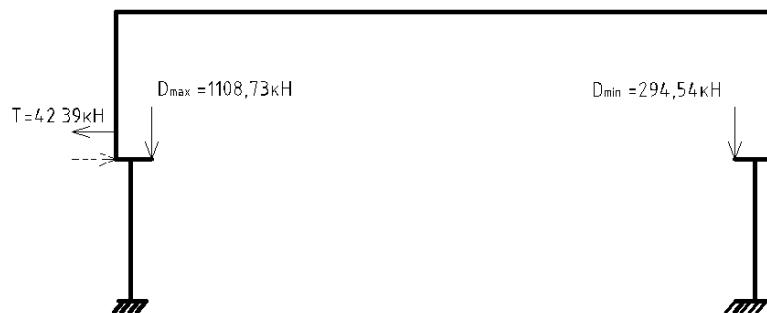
Расчетная схема рамы. Вертикальные и горизонтальные крановые нагрузки.
